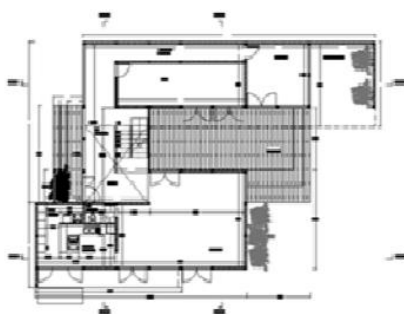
Planta do piso 1, (Metalusa, 2015)
